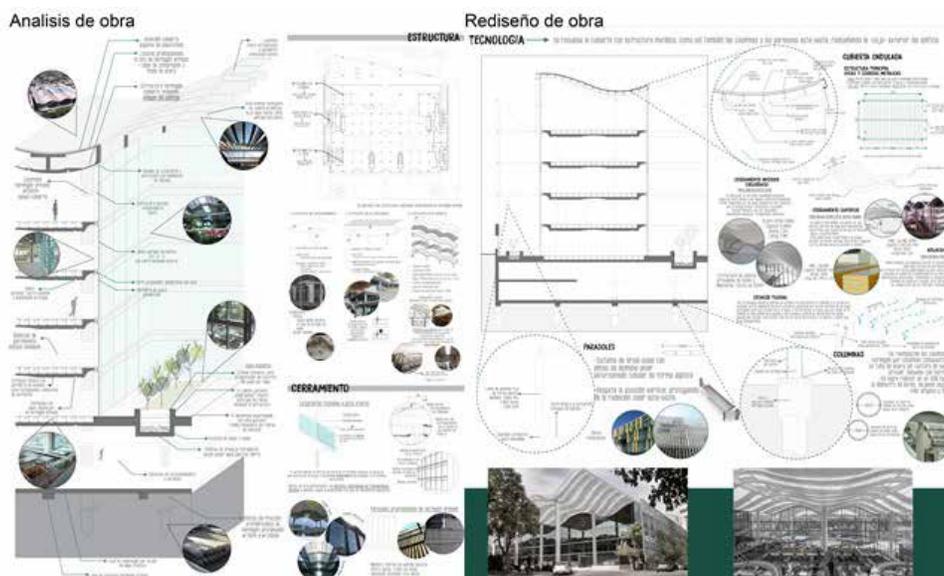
Cambio de estereotómico a tectónico. Fuente: Elaboración propia en base a TPG y TPI de CIV de las alumnas Noya, Falchi y Van Schaik.
